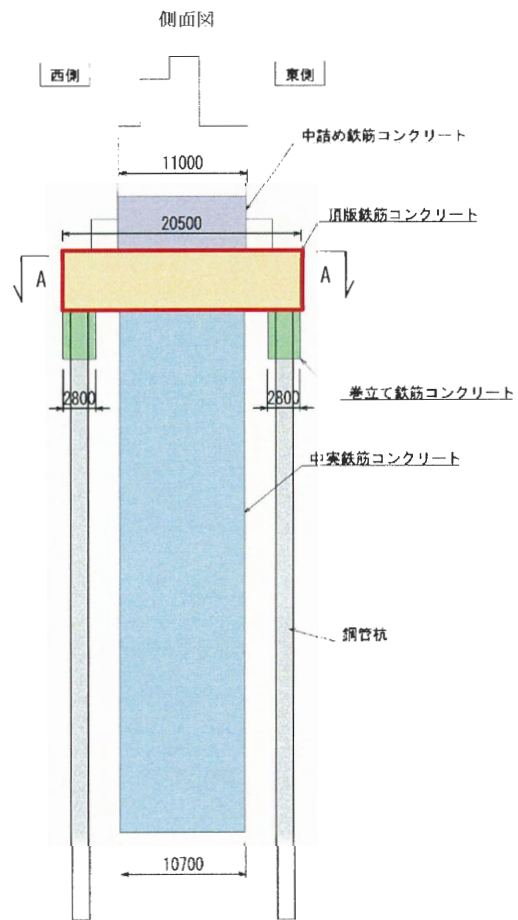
頂版鉄筋コンクリートの配筋図 (1/3)
